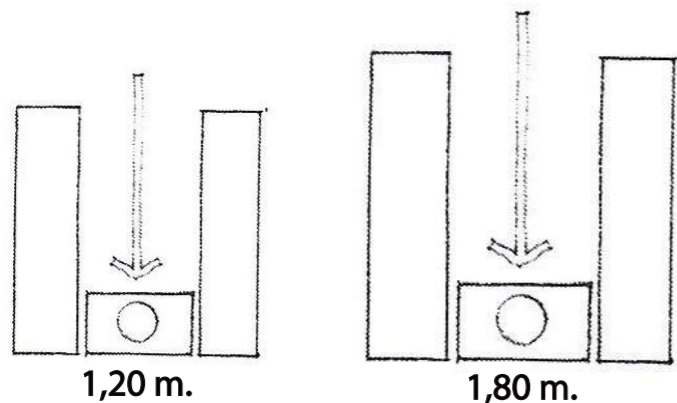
Dimensiones mínimas de corredores o pasillos "tomado de Chin F.D. & Castán"
